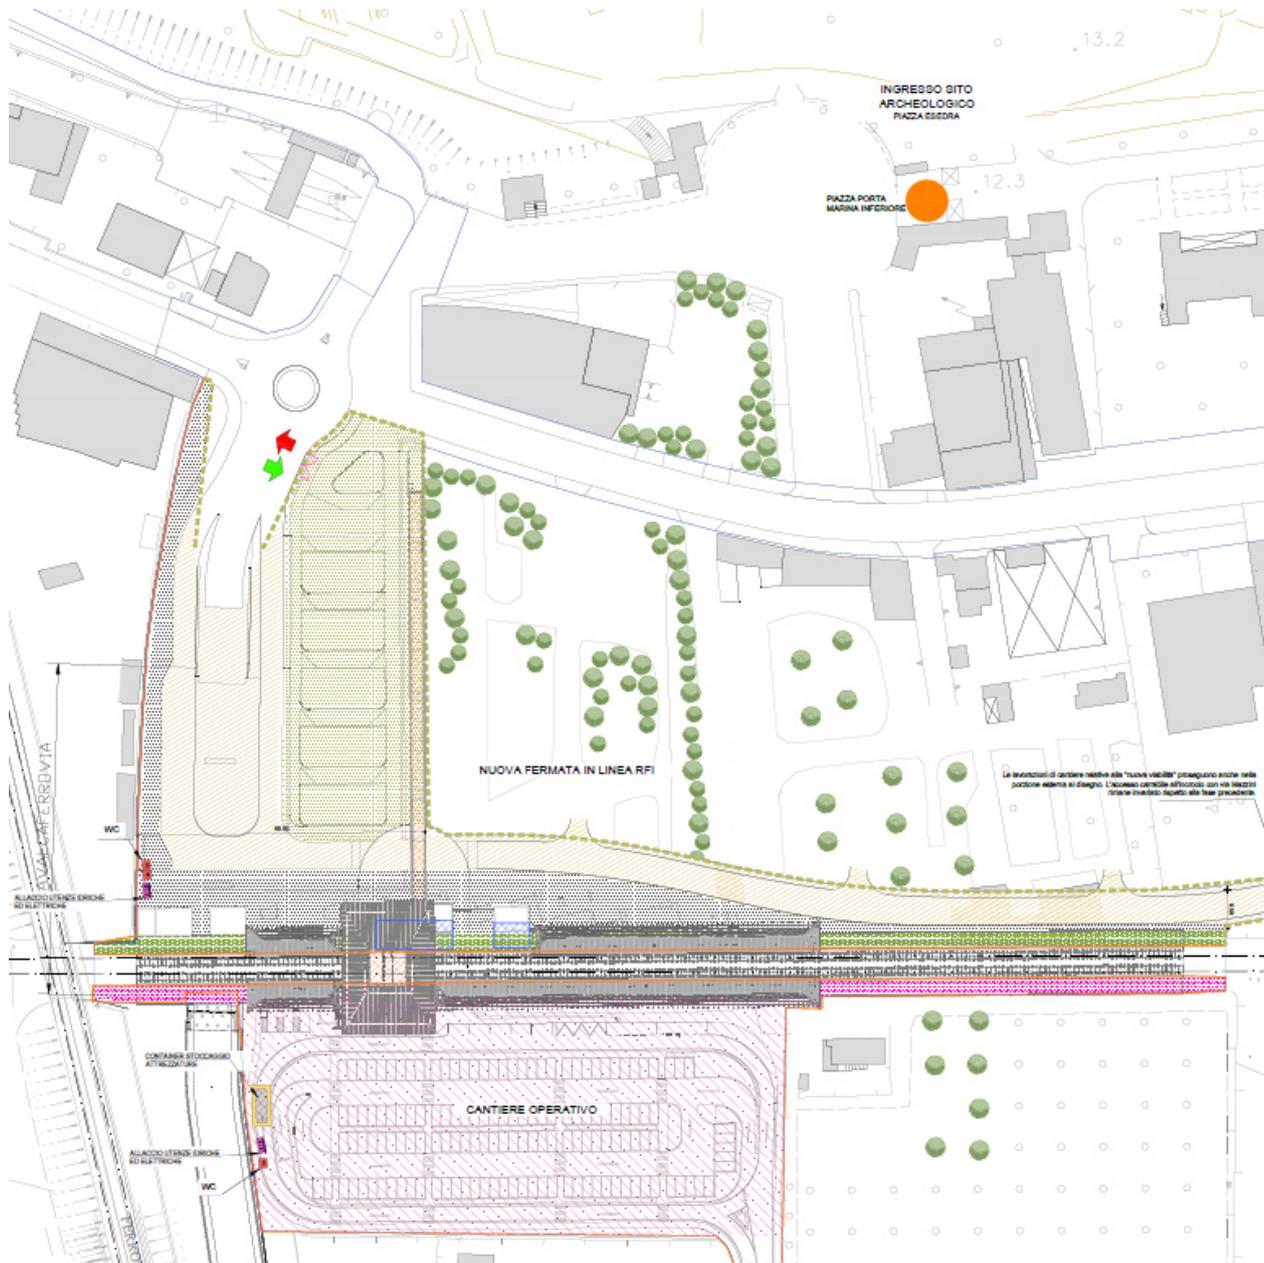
FASE 3 – Lato Ingresso scavi Piazza Esedra
